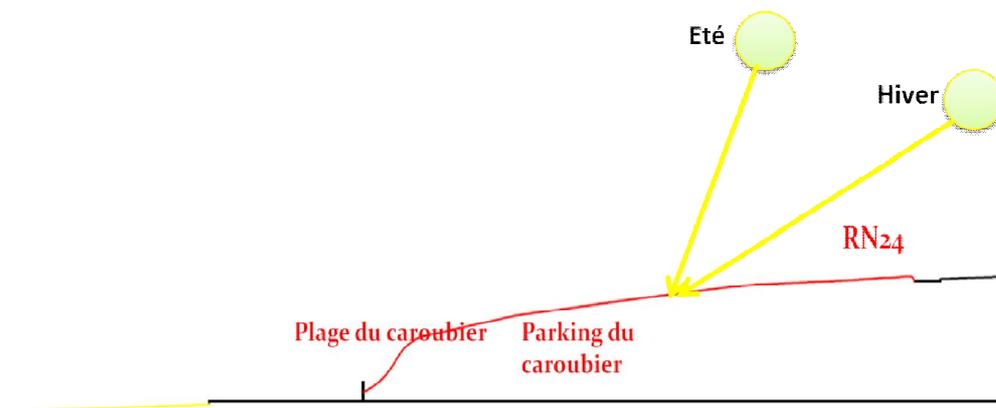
trajectoire du soleil par rapport au site sur la coupe longitudinale
